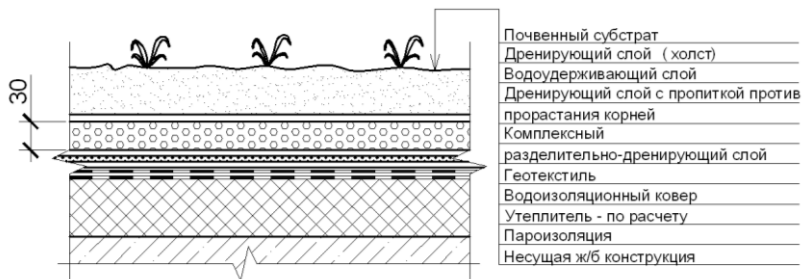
Зеленая кровля по грунтовому слою по жесткому плитному утеплителю
